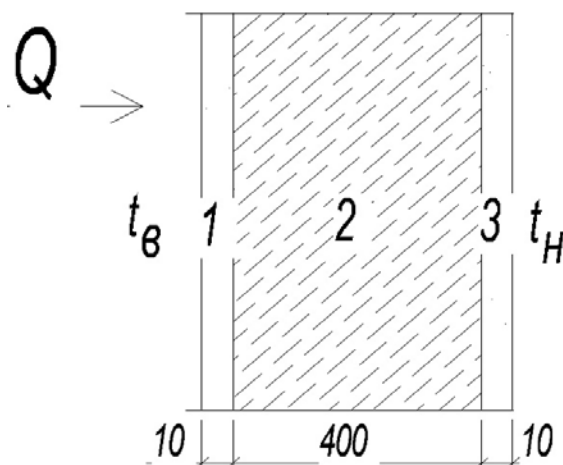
Исходная конструкция наружной стены второго этажа
